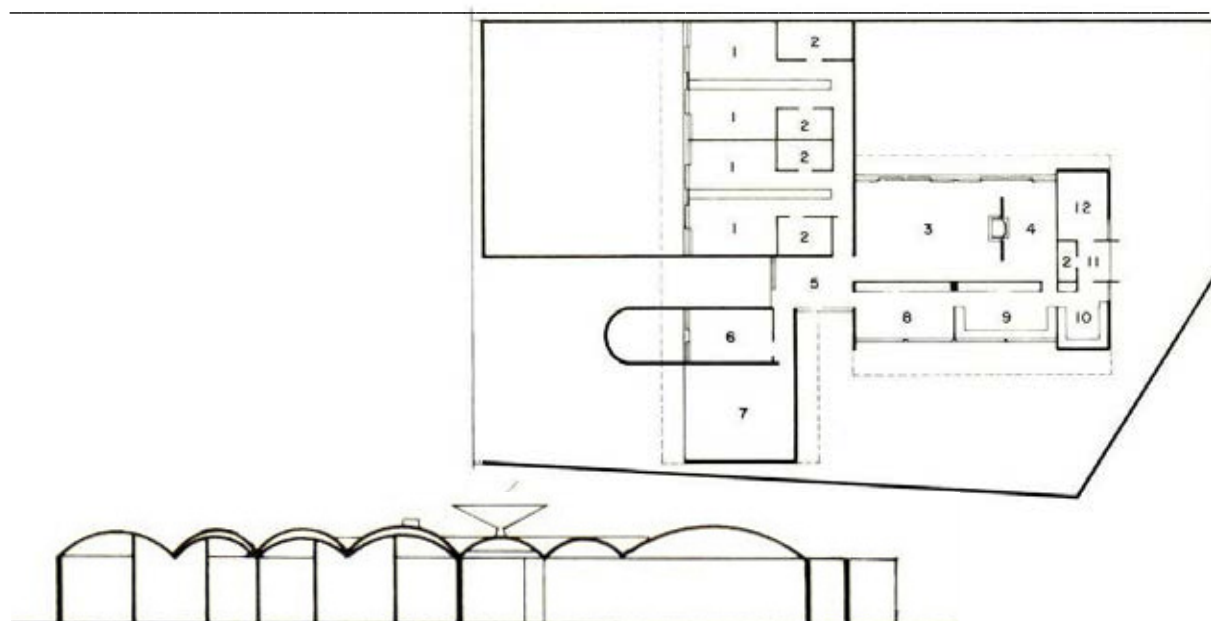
planta térreo: 1) quartos; 2) banheiros; 3) estar; 4) jantar; 5) hall; 6) biblioteca; 7) garagem; 8) s. íntima; 9) cozinha.
